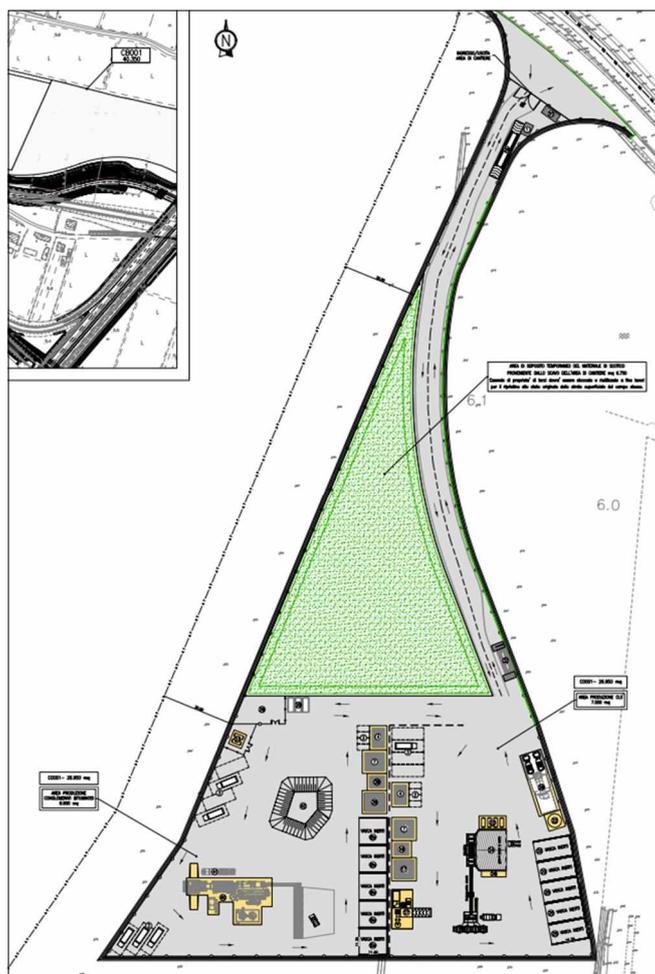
Layout dell'area di cantiere CO01 (agg a PE da SIC5310)
